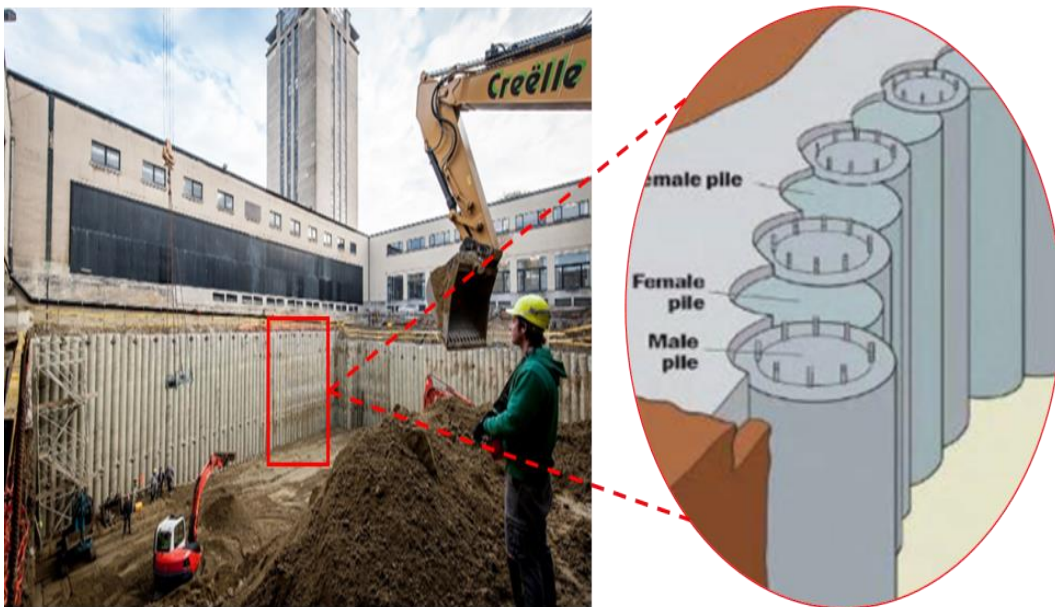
Pieux sécants, soutènement de fouille.
